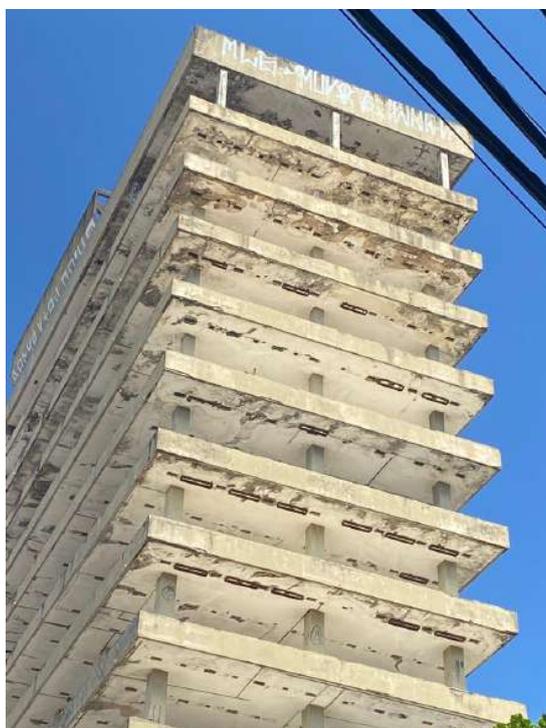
Diversos pontos de infiltração, armadura a mostra nos pavimentos (lajes, pilares e vigas)
